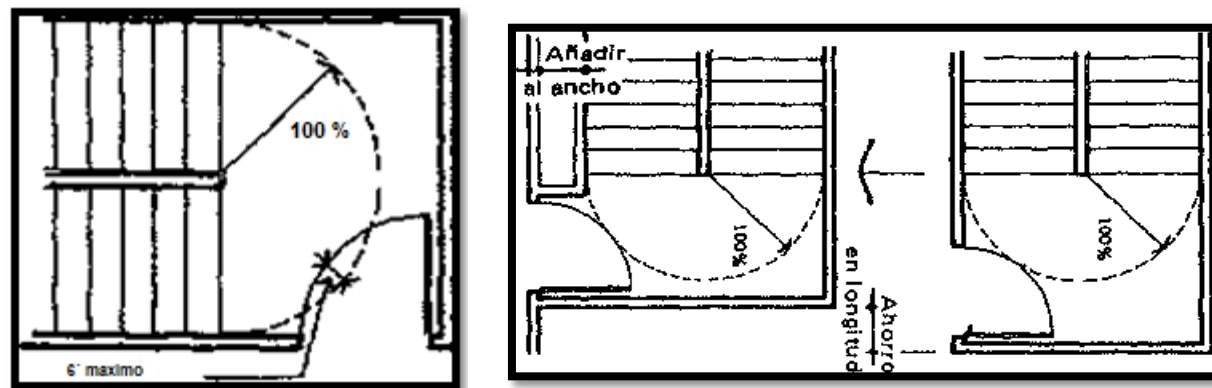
y 18. Dimensiones mínimas de ancho de descansos.
